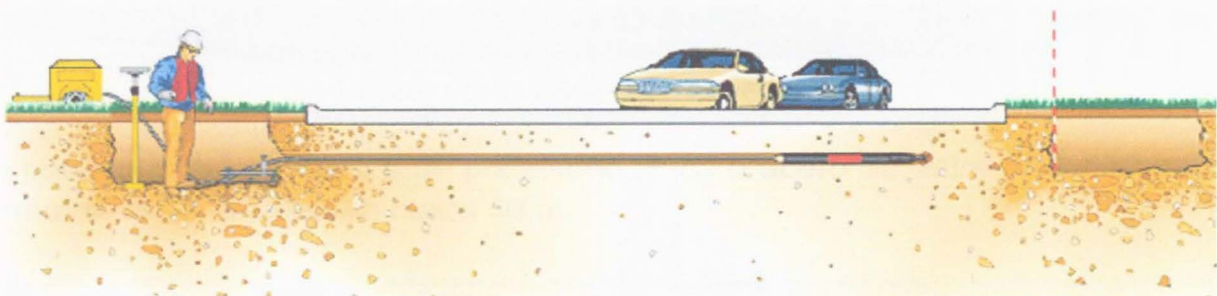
INSTALACIÓN DE TUBERÍAS SIN ZANJA⁸
